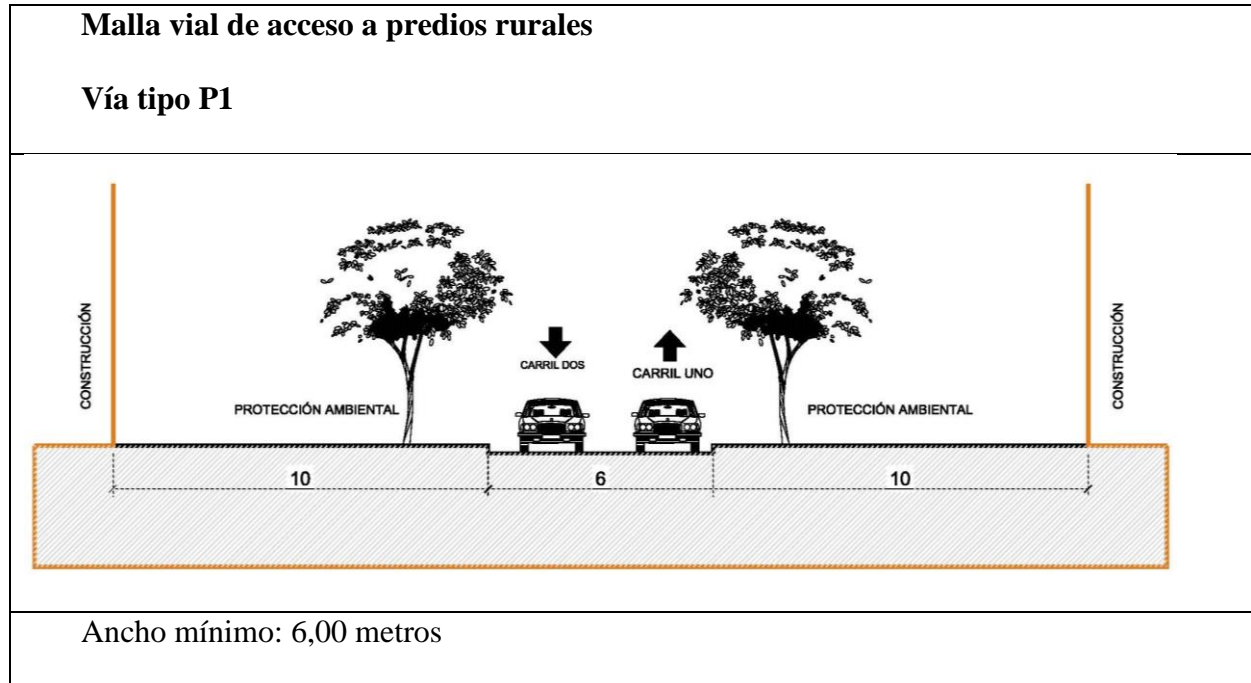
Perfil vial tipo P1. Fuente: POT Barrancabermeja.
